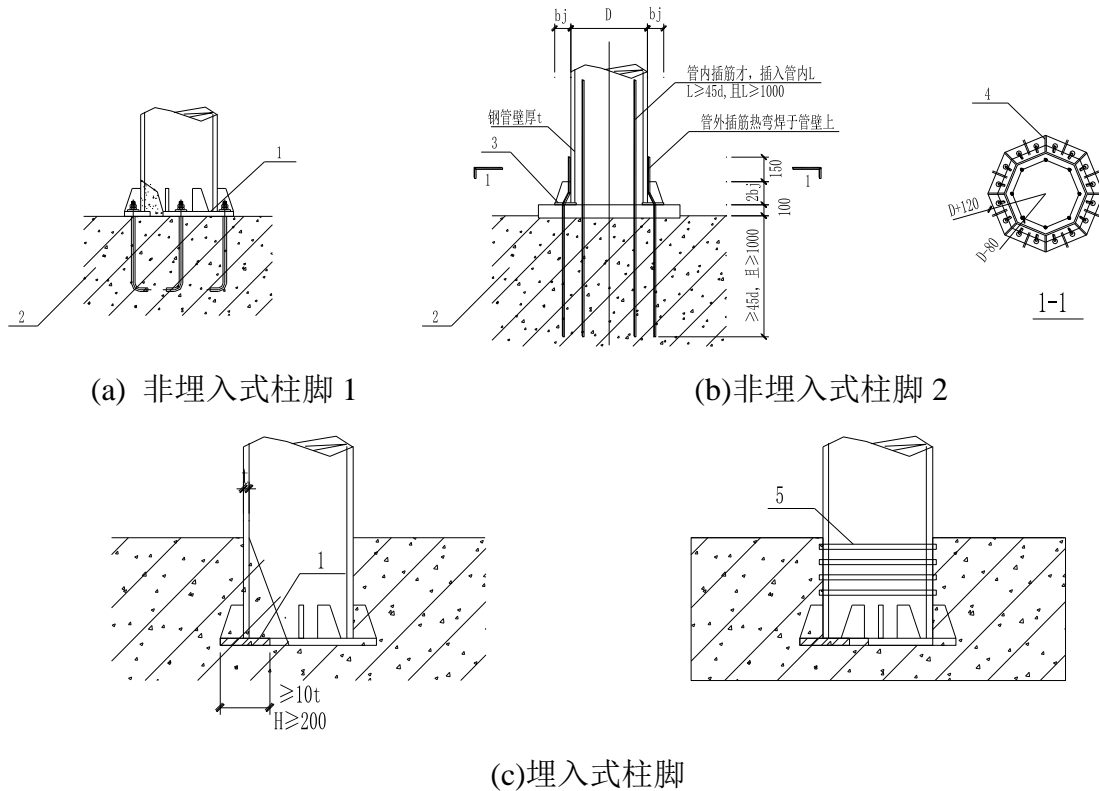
圆形钢管混凝土柱的柱脚构造示意
